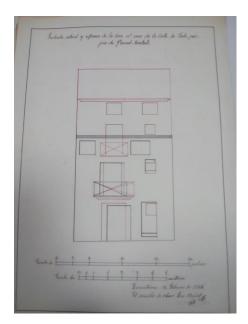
Plano de reforma de sobreelevación de las plantas de una vivienda
